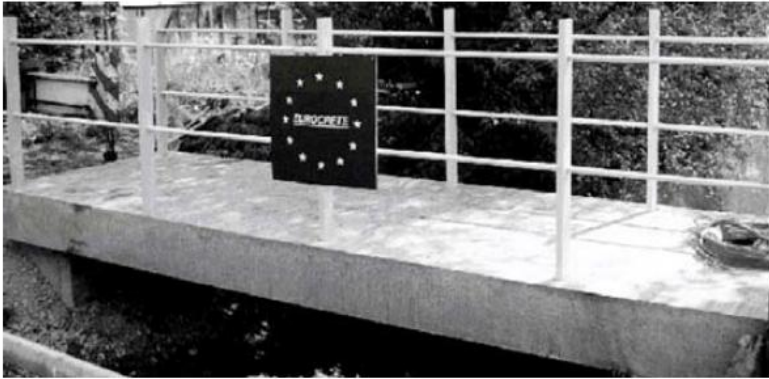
Puente totalmente armado con redondos de FRP. EUROCRETE Project
